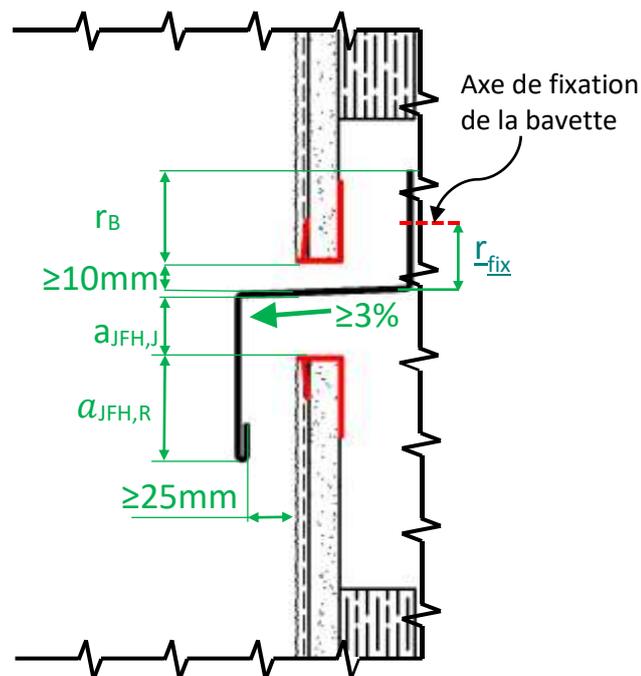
cotes appliquées à la bavette et au bardage cas d'une finition enduite
